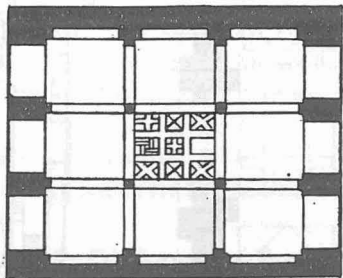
Planta de la Mezquita de las Tornerías (s. XII). Toledo.
